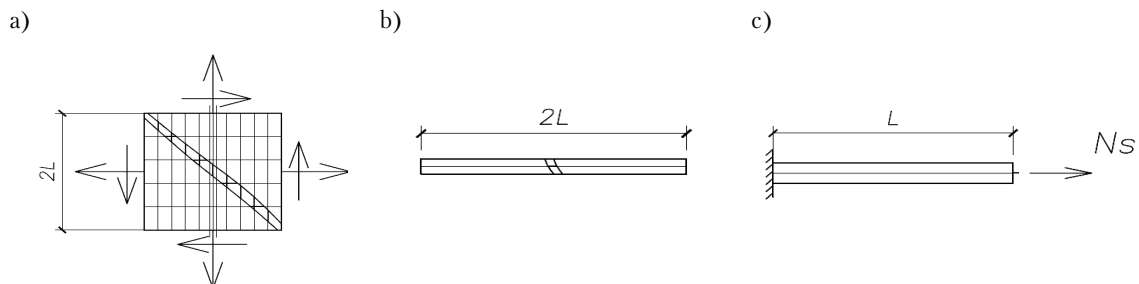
Растянутый железобетонный стержень с одиночным армированием в центре: а) железобетонная пластина с трещиной; б) вырезаемая полоса; в) исходный объект моделирования.
